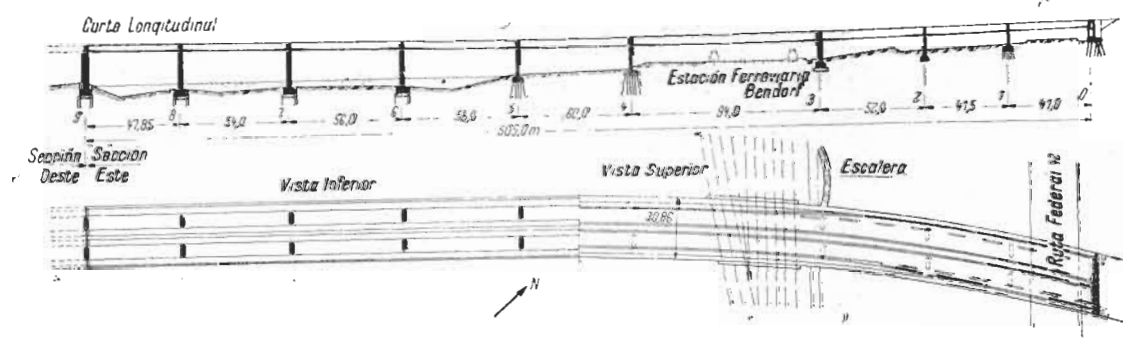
Puente Bendorf, sección II (este); corte longitudinal y planta.
